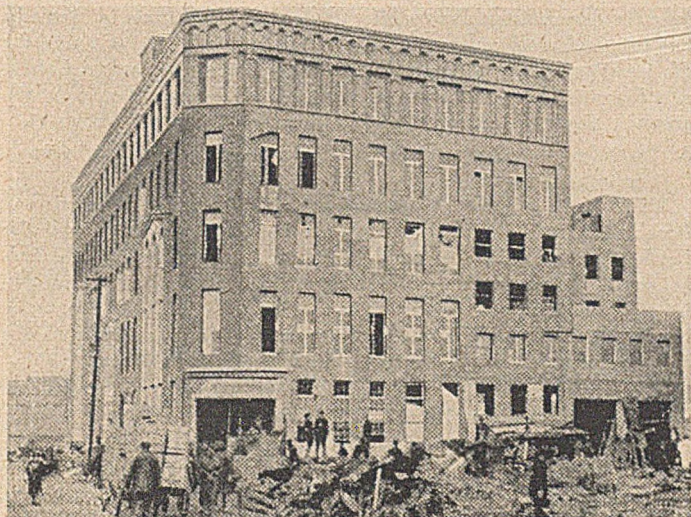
Stahlbetonbau in Tokio (unversehrt beim Erdbeben 1923).
